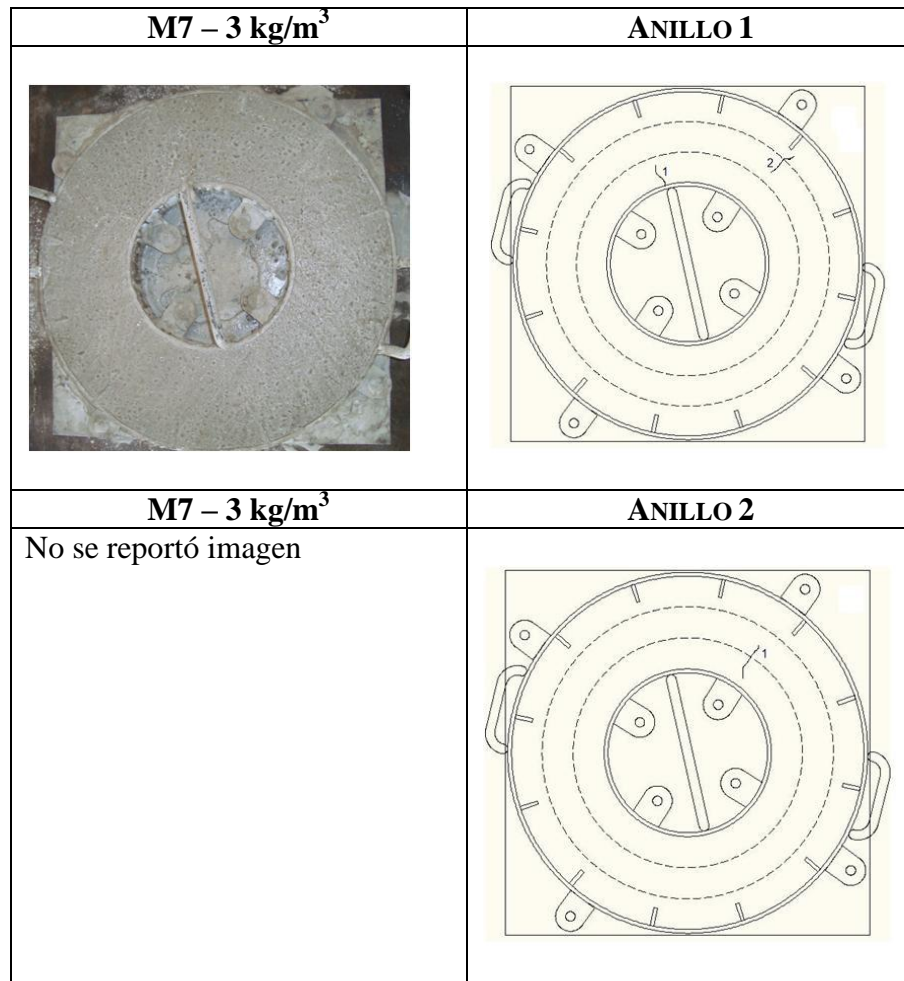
Grietas de Contracción Plástica de la Mezcla 7
